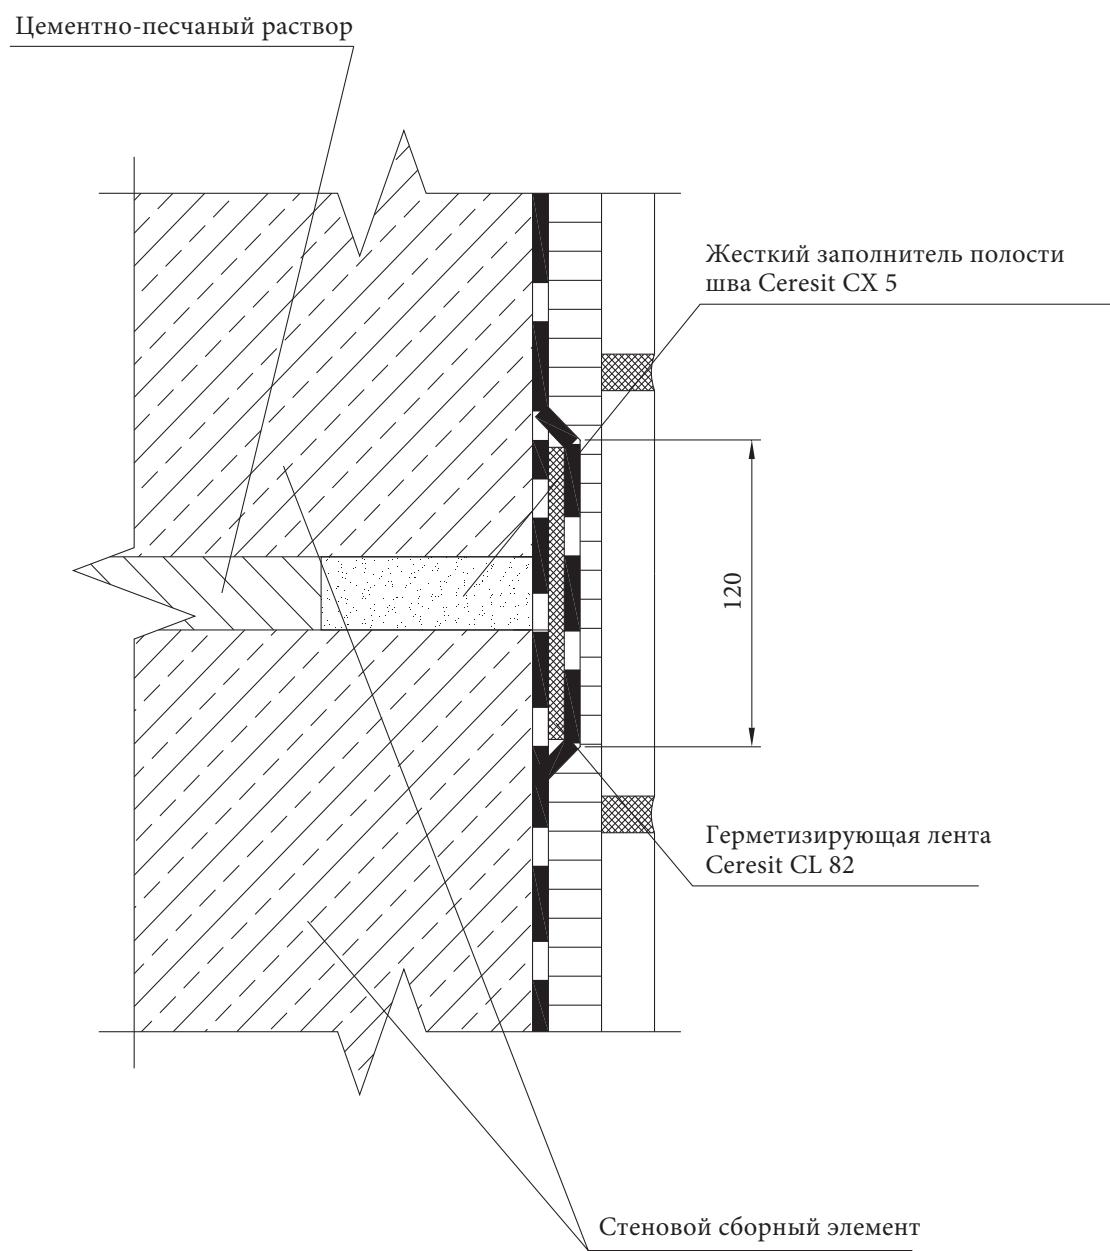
Усиление внутренней гидроизоляции шва между сборными элементами стены (узел Г)
